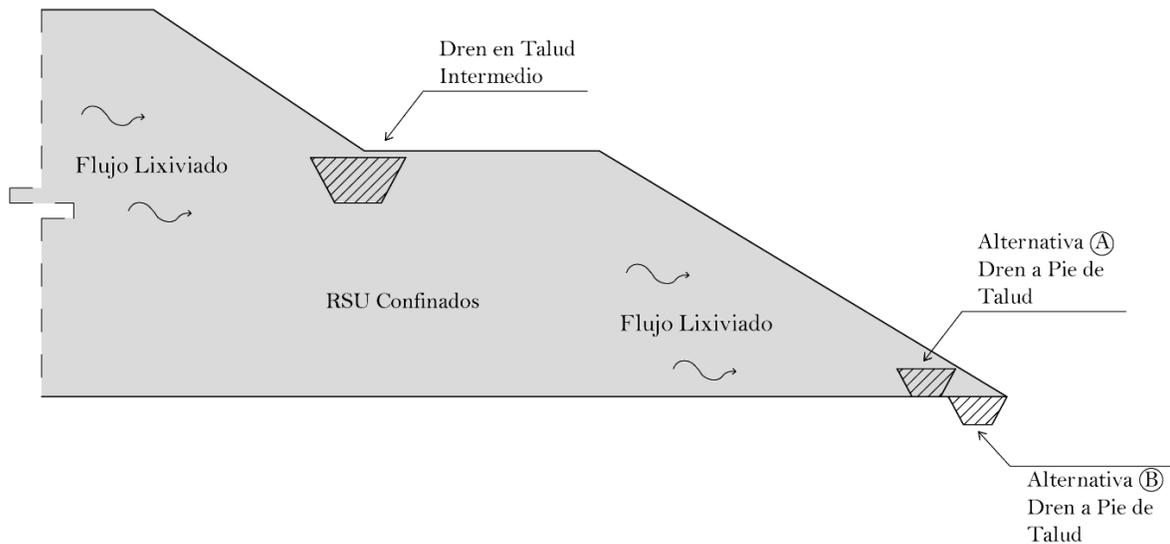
Diagrama de alternativas de drenes trapezoidales a pie de talud para captación de lixiviado
